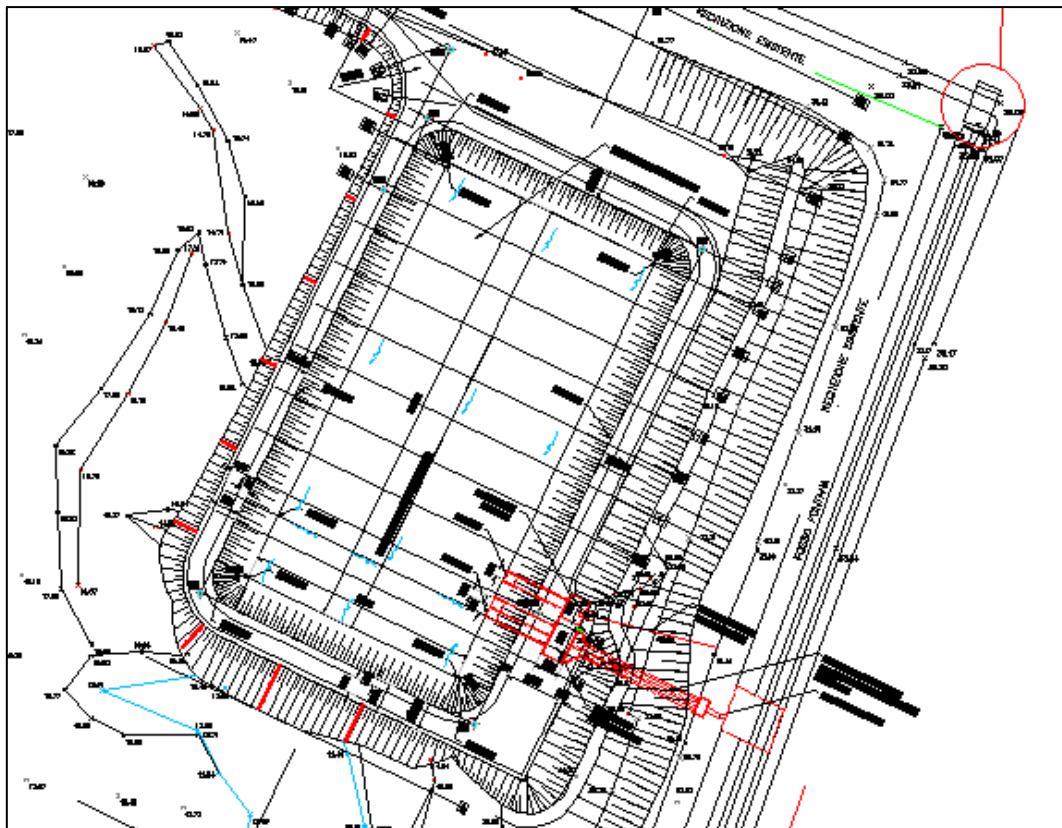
Planimetria della Vasca di laminazione presso la cava Olmi.
